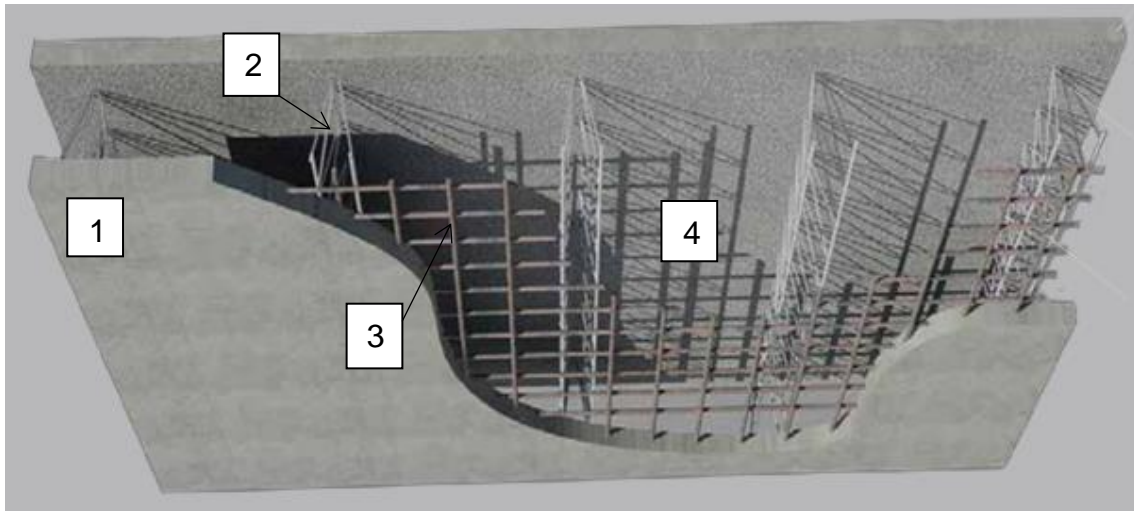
Configuración de un muro doble. 1- Losa; 2- Vigas de celosía; 3- Armadura de las losas; 4- Hueco para la armadura del muro doble y el relleno de hormigón.
